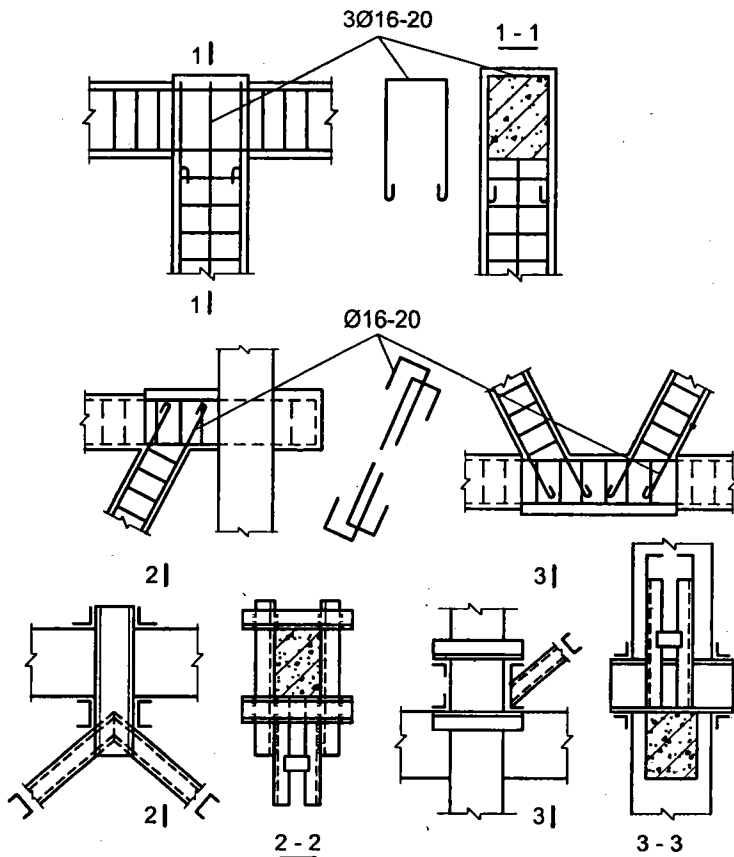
Sơ đồ gia cố kết cấu bằng cách đặt thêm gối tựa cứng
